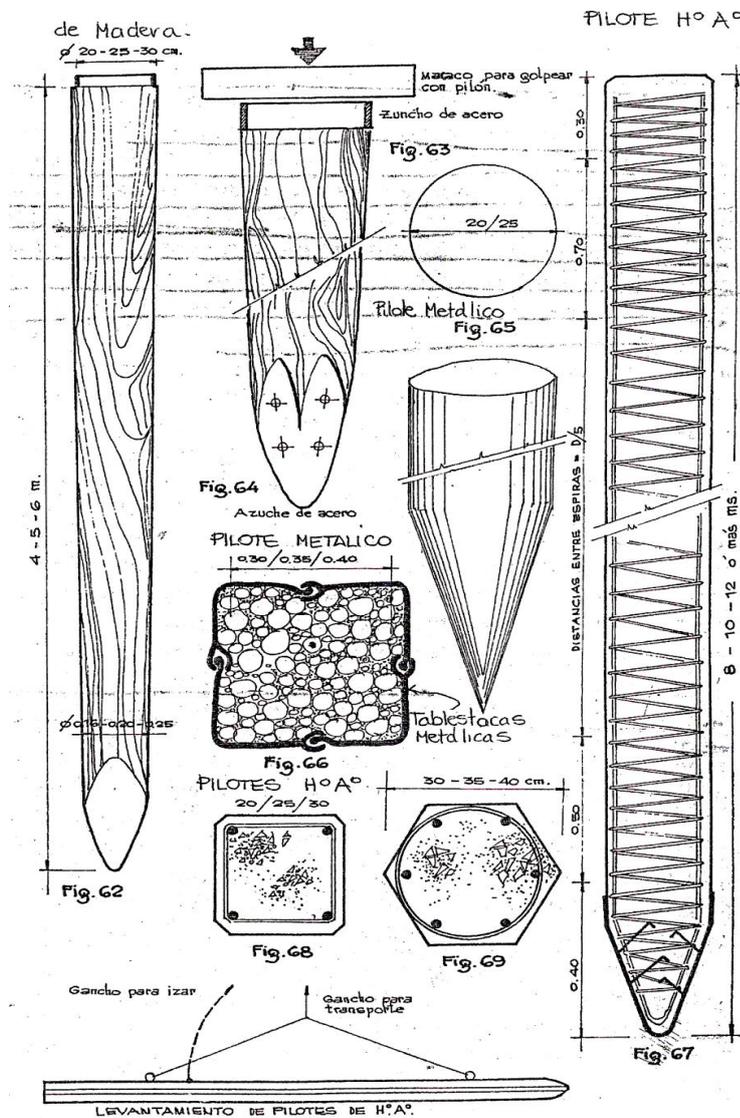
a 64: pilotes de madera. Figura 65: pilotes metálicos. Figura 66 a 69: pilotes H°A°
